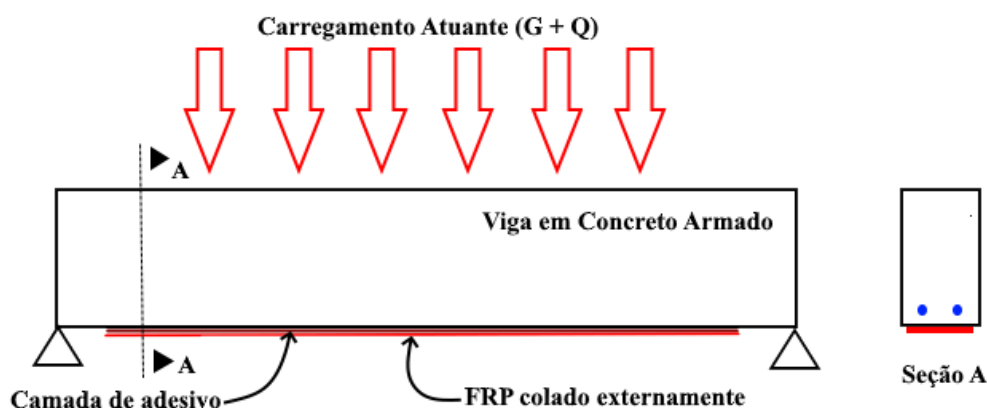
Arranjo típico de reforço de vigas com FRP colado externamente (EBR).
